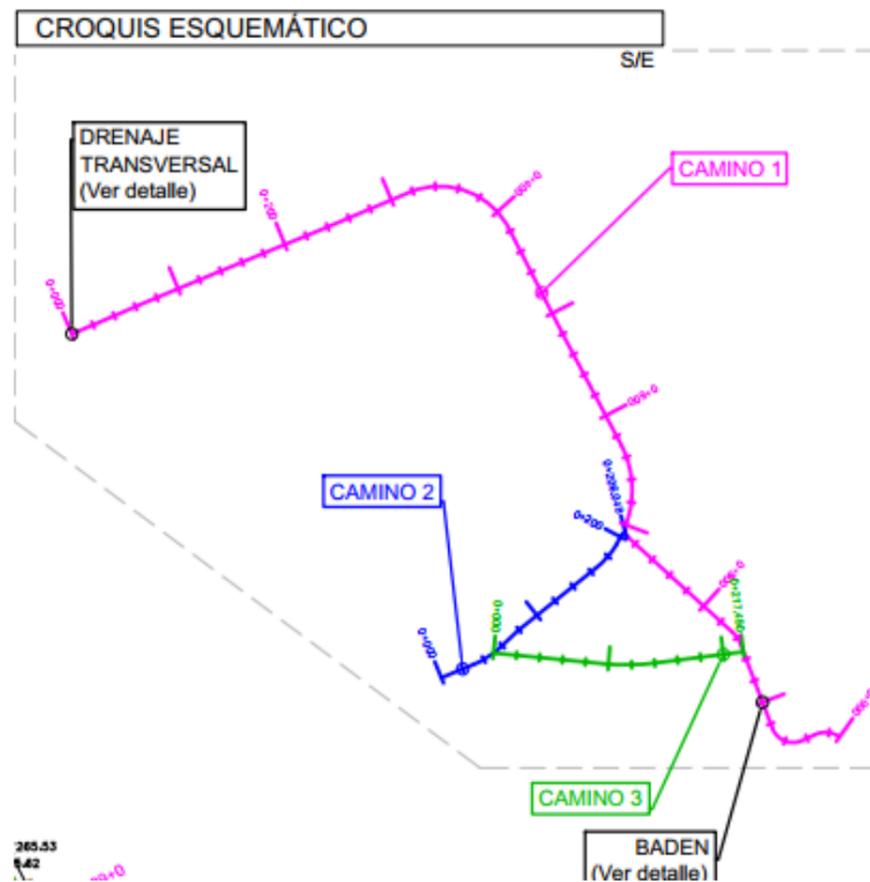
Ejes de caminos de acceso balsa Los Almagros
